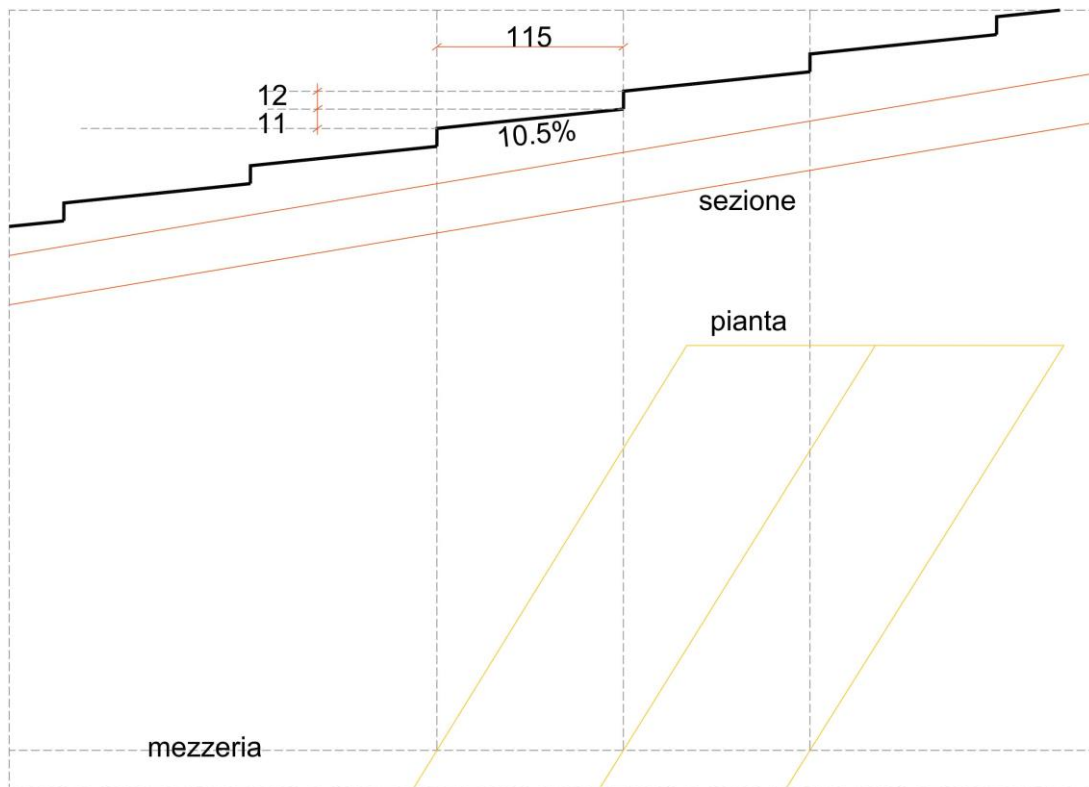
Profilo altimetrico e sezione tipo della nuova via gradinata
